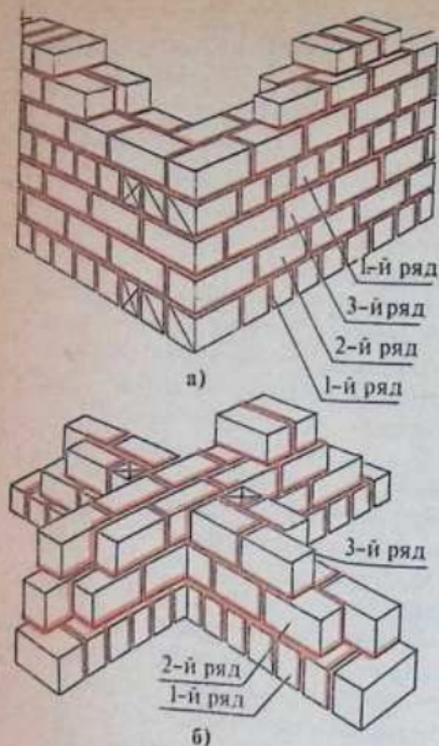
Трехрядная перевязка кладки из бетонных камней при толщине кладки 390 мм:
